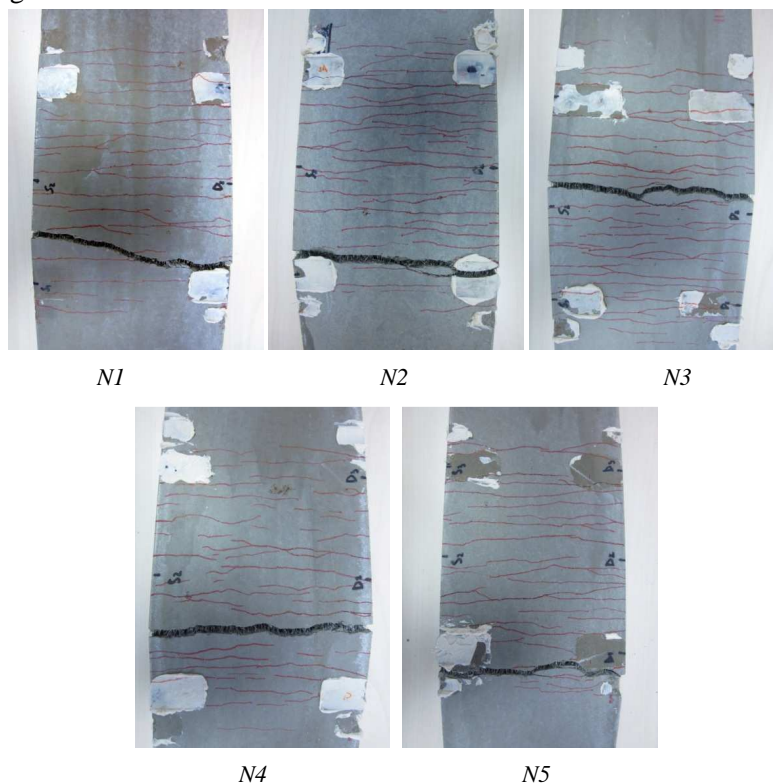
Particolari della multifessurazione esibita dai travetti strutturali
